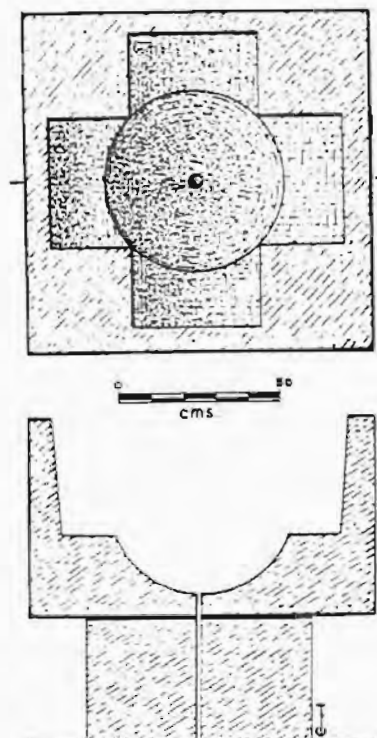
Gormaz. Planta y sección de la pila bautismal.
